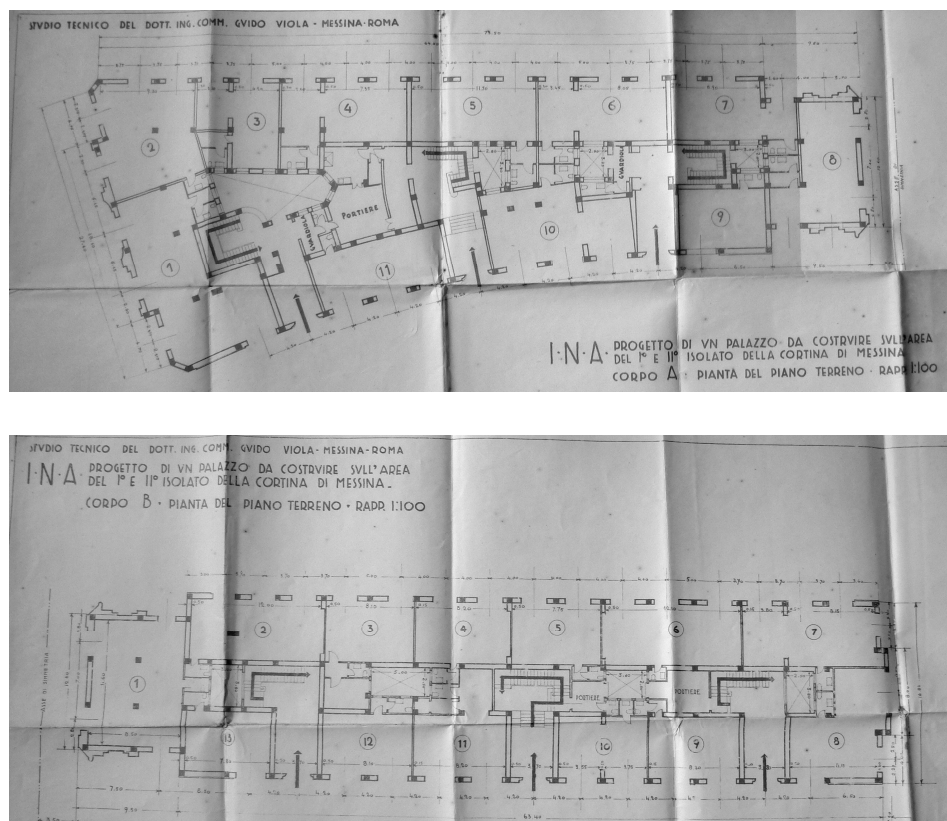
pianta piano terra corpo A (a), pianta piano terra corpo B (b)
